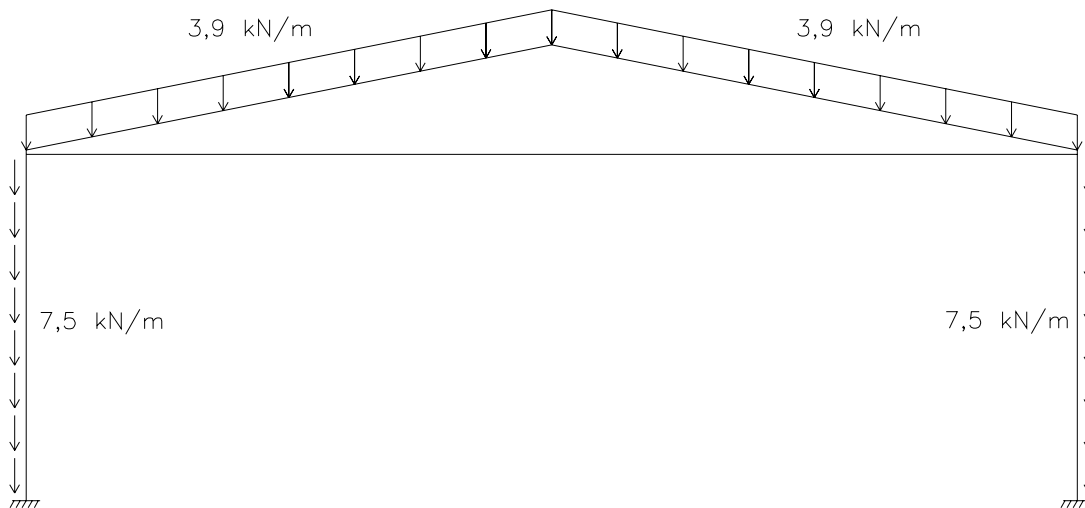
Pórtico utilizado para o sistema de ligação viga-pilar com chumbadores e consolo horizontal (exemplo 5.1).
